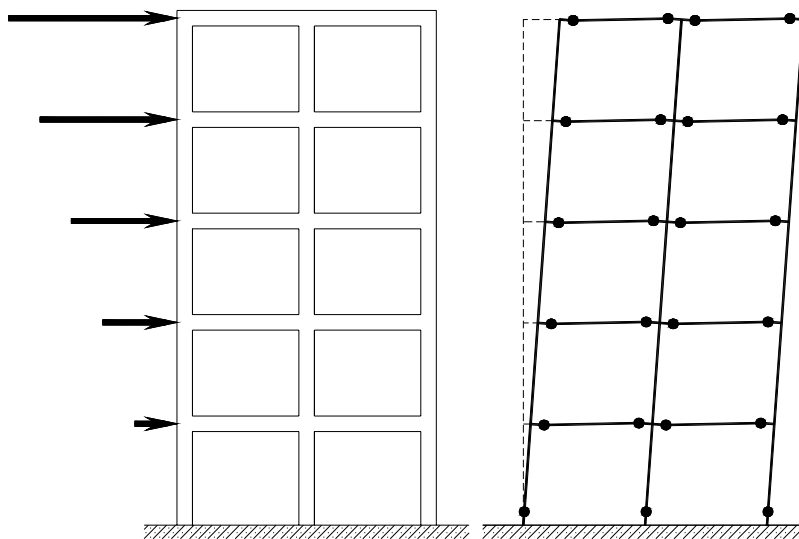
Mecanismo de colapso columna fuerte-viga débil para un marco de concreto
